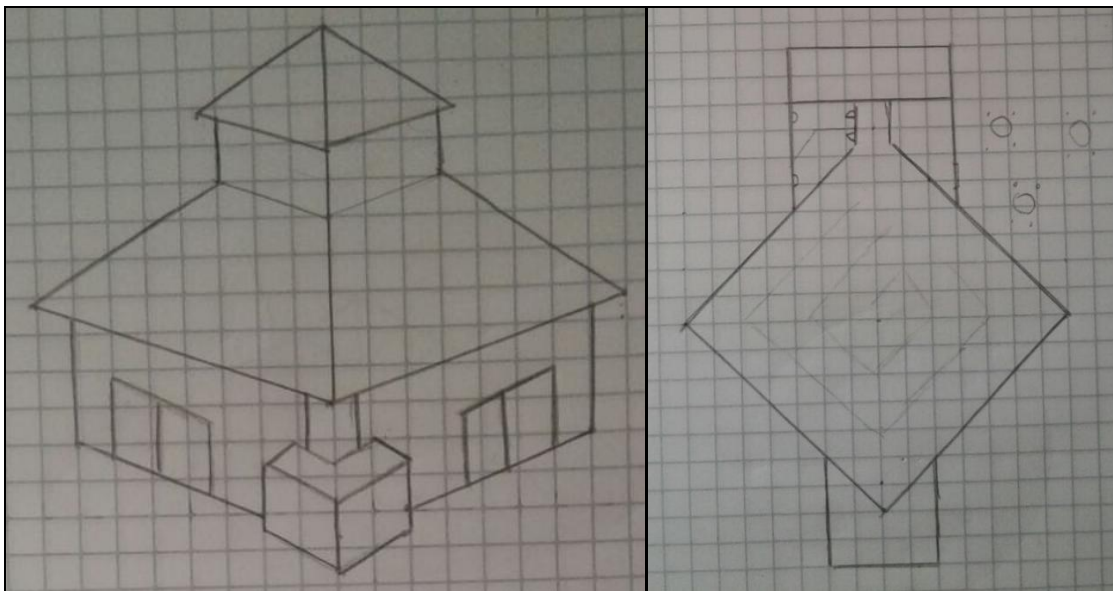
Bosquejo propuesta N° 1 vista en planta y alzado
